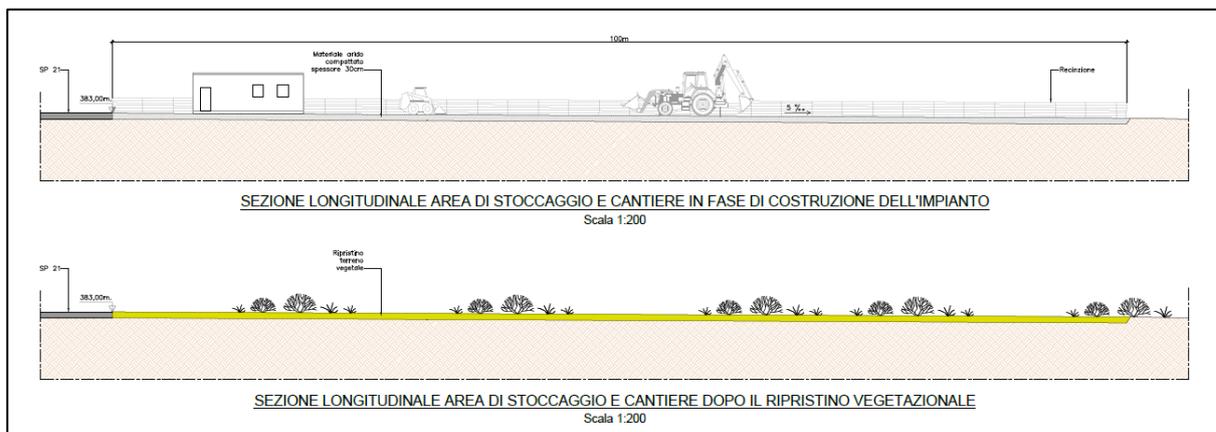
Area di cantiere in fase di costruzione dell'impianto e in esercizio
